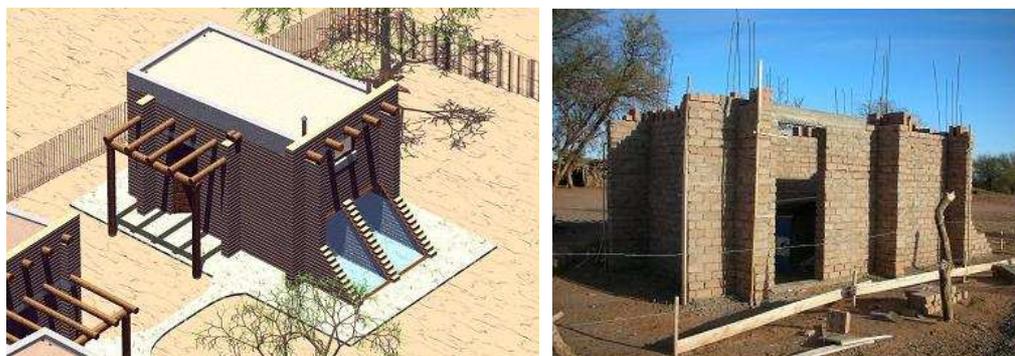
Foto de maqueta digital de la LSS y estado actual de construcción.
